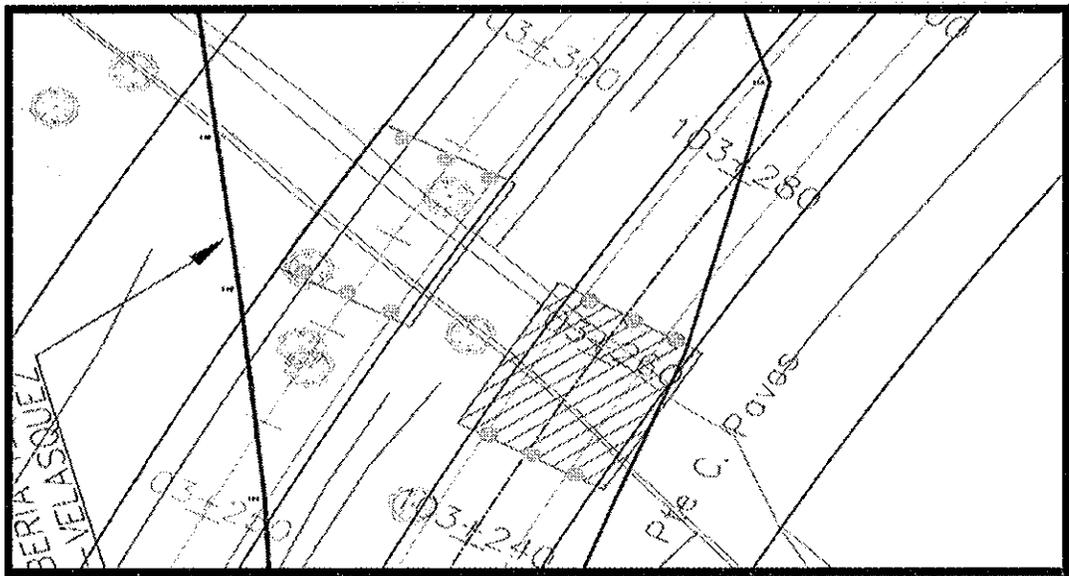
acercamientos críticos con estructuras viales (Puentes) e infraestructura petrolera
